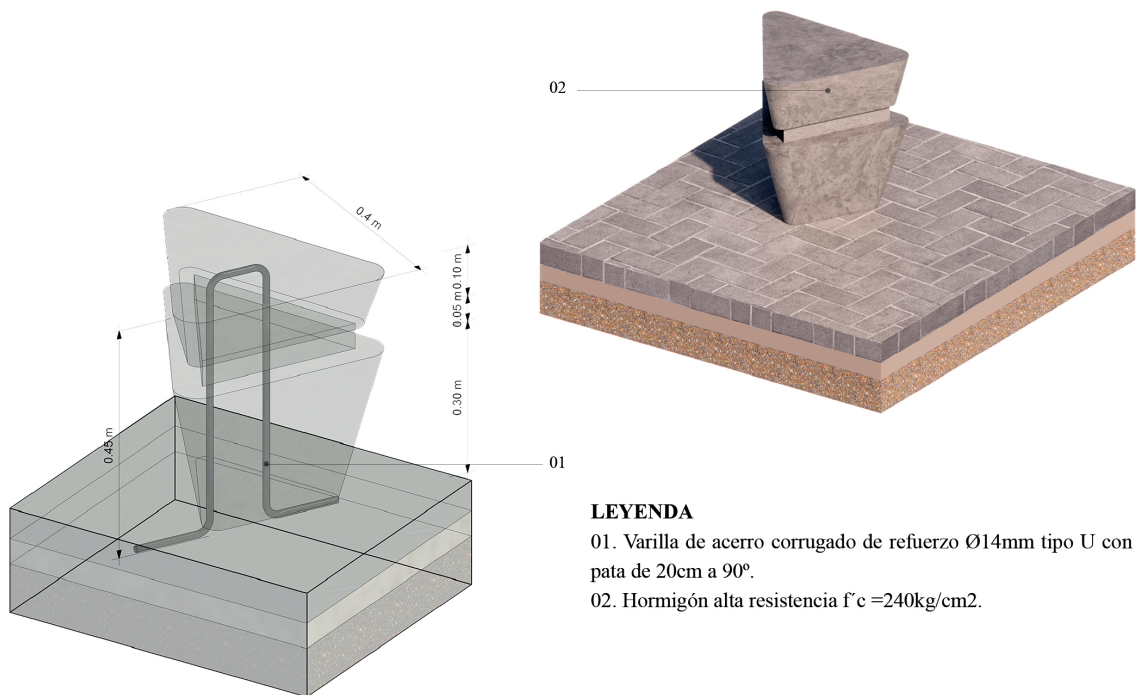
Análisis del sistema constructivo de bolardo. Elaboración: Autoras.
